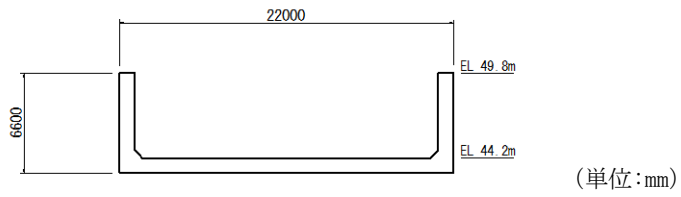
輪谷貯水槽 (東側) 断面図 (B-B断面)
